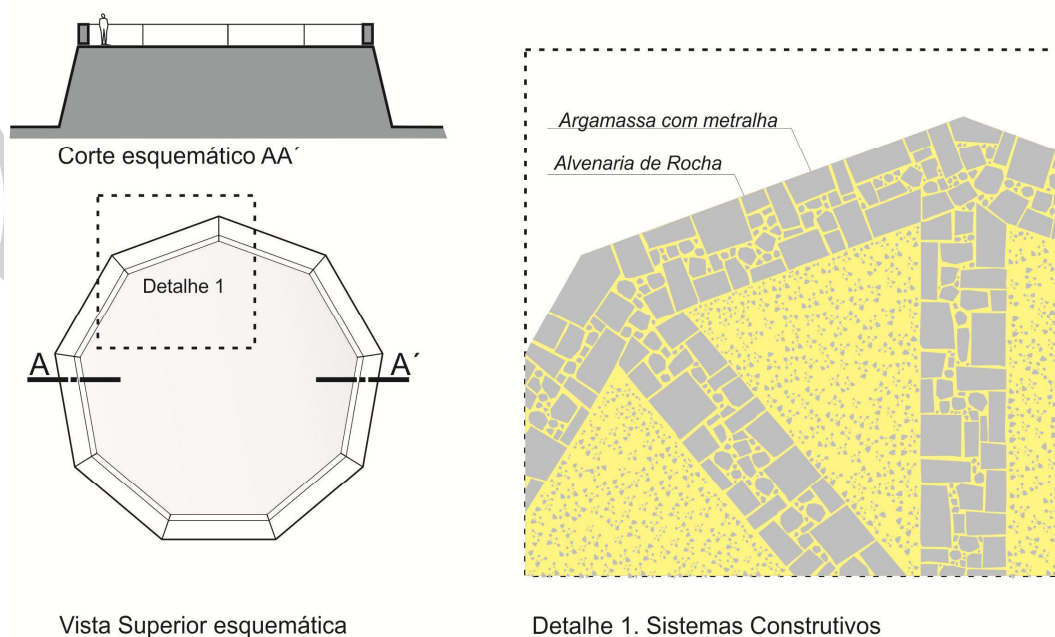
Planta baixa e detalhe da alvenaria de rocha e preenchimento de argamassa de cal com metralha do Forte de São Francisco da Barra.
